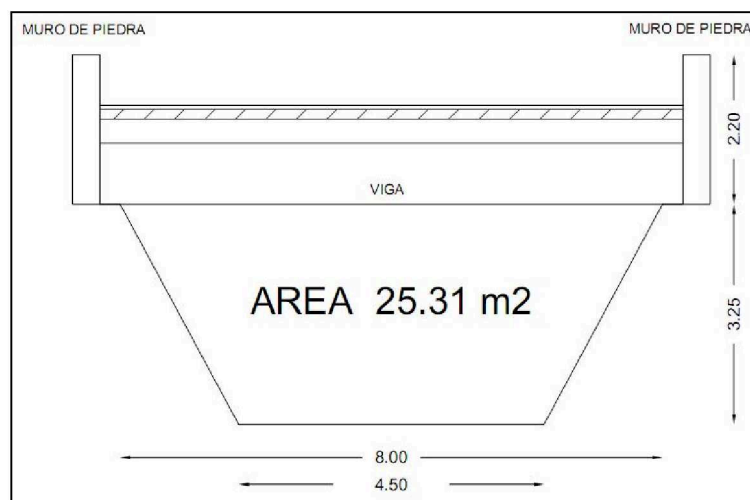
Sección transversal del canal Esteco en la estación de aforo.
